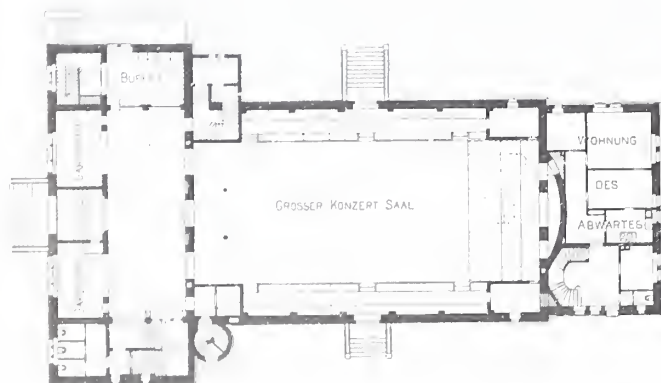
Saalbau. — Grundriss vom Erdgeschoss. — 1:600.
